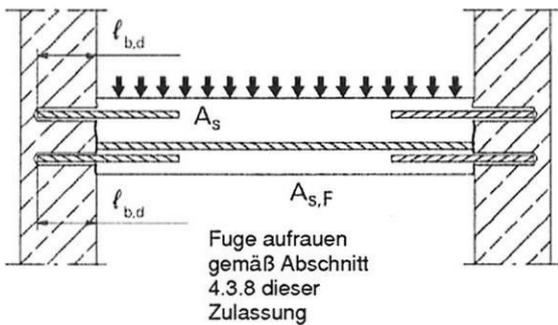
Bewehrungsanschlüsse überwiegend auf Druck beanspruchter Bauteile
